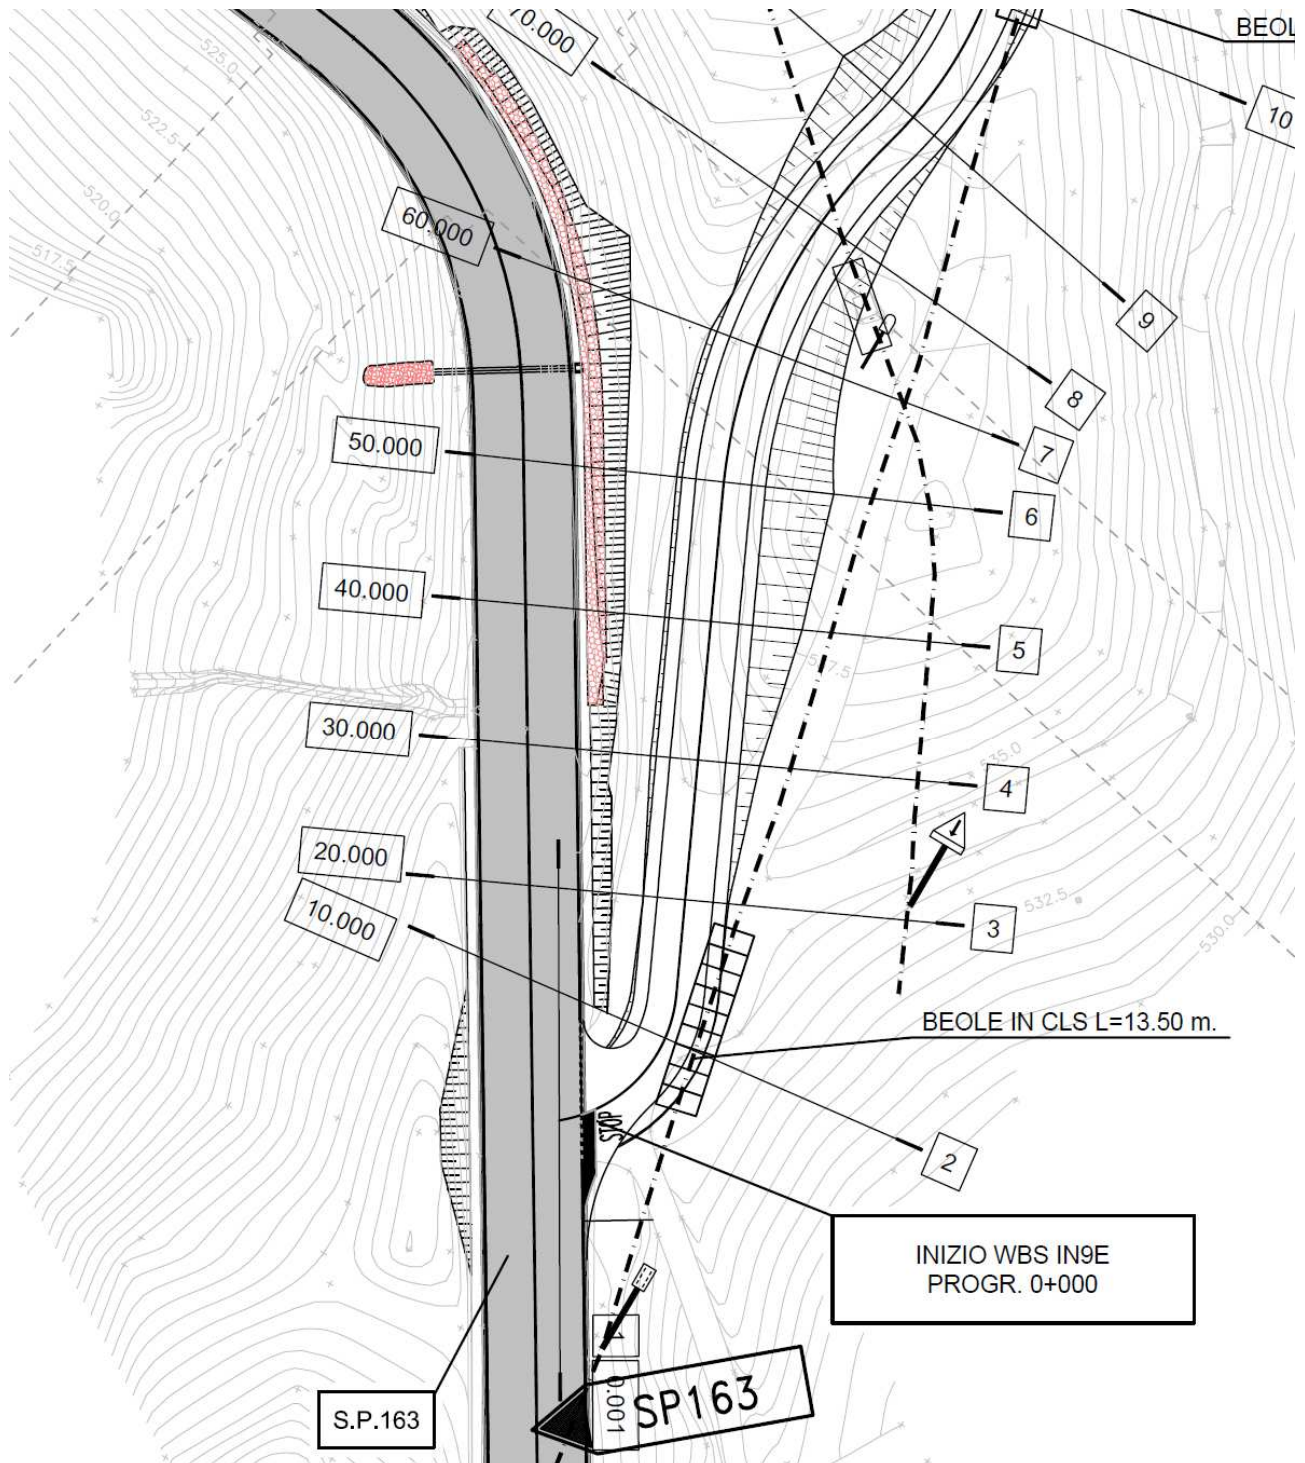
Stralcio planimetrico in corrispondenza della sezione di calcolo n. 6 alla pk 0+050.0
